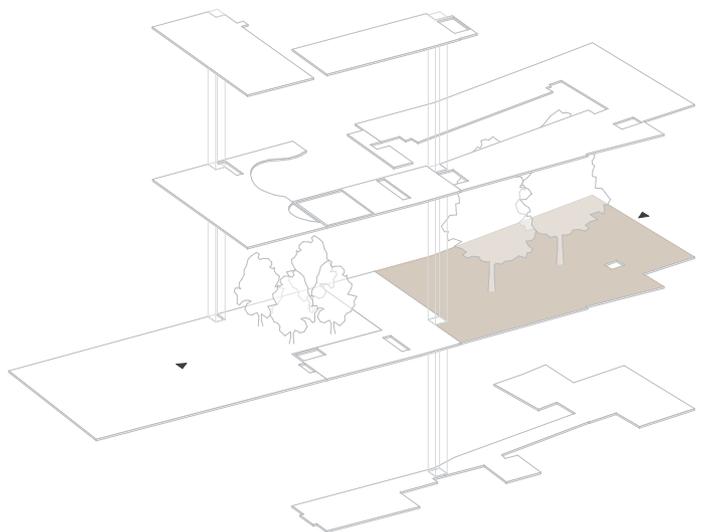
| Grundriss Erdgeschoss. Wohnung 05 159
